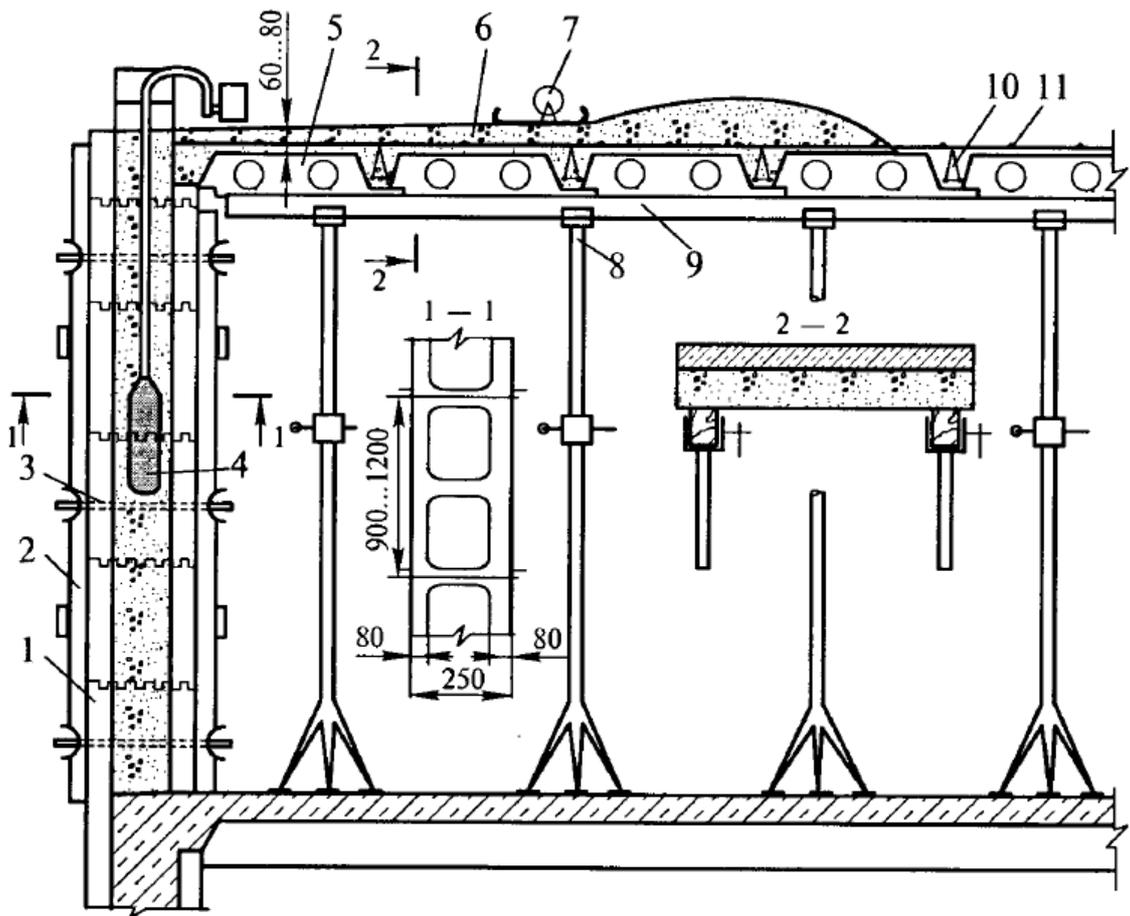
Схема устройства наружных стен и перекрытий в несъемной опалубке:
